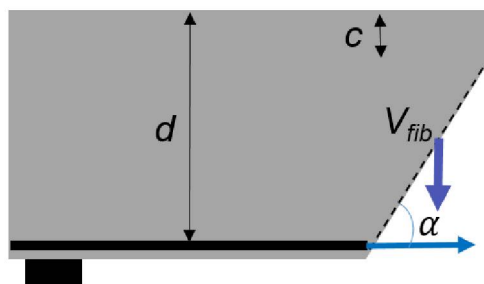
Parâmetros associados à cinemática da fissuração
